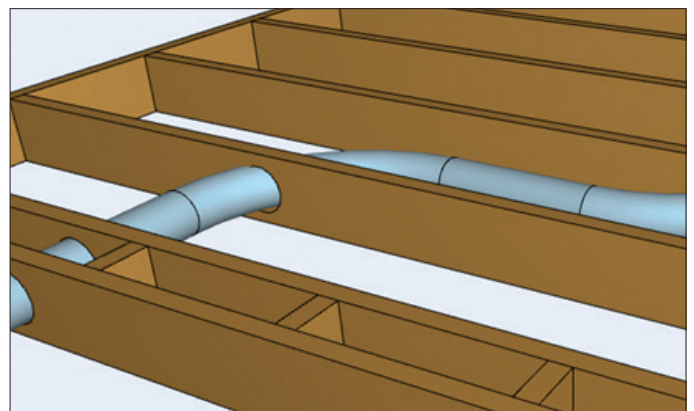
• Postopek izdelave stropnih elementov (Archiframe, 2019).
